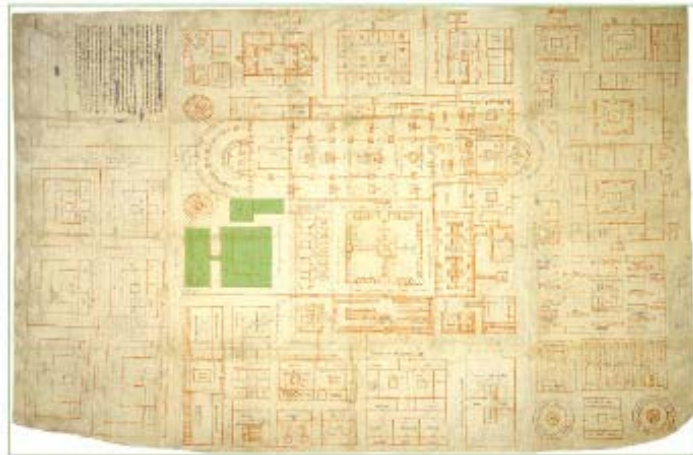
Klosterplan, Planausschnitt Abtpfalz
